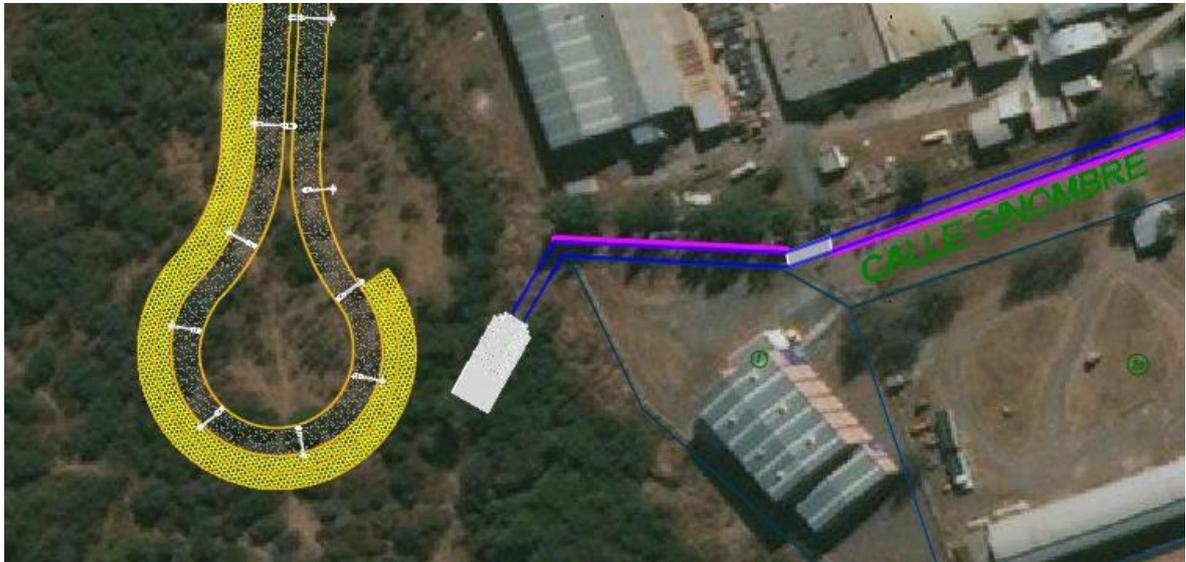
Esquema de Obras de Descarga Canal N° 4
